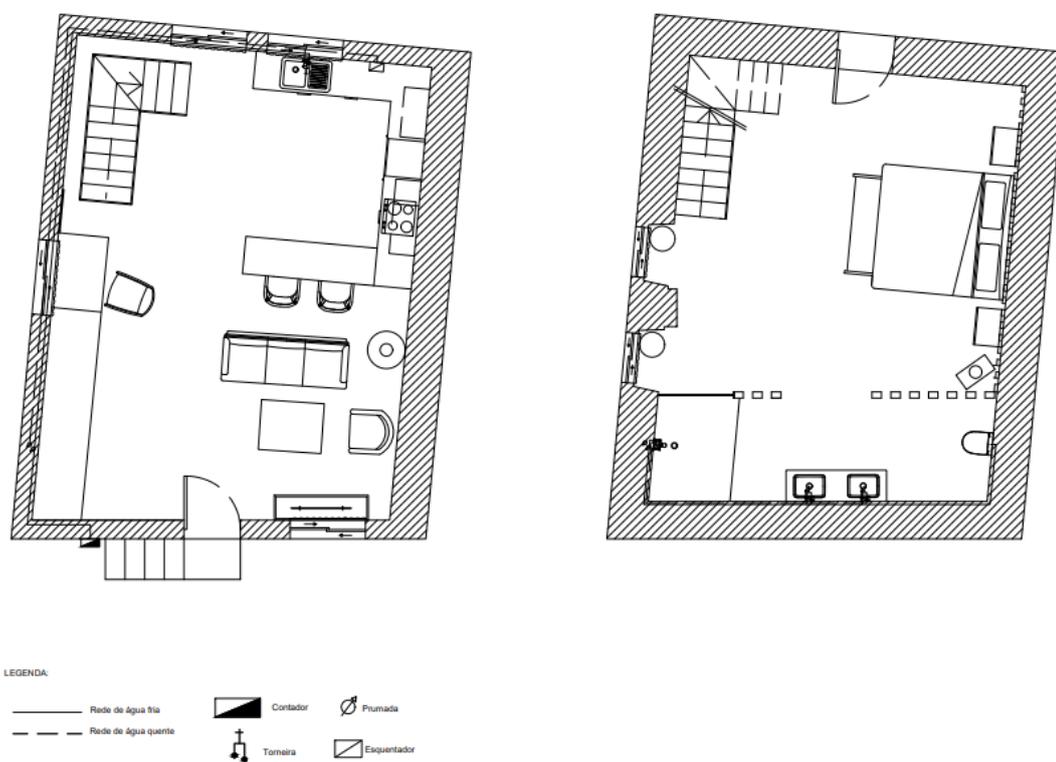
Planta de rede de águas piso 0 e piso -1. Fonte: Maria Leonor.
